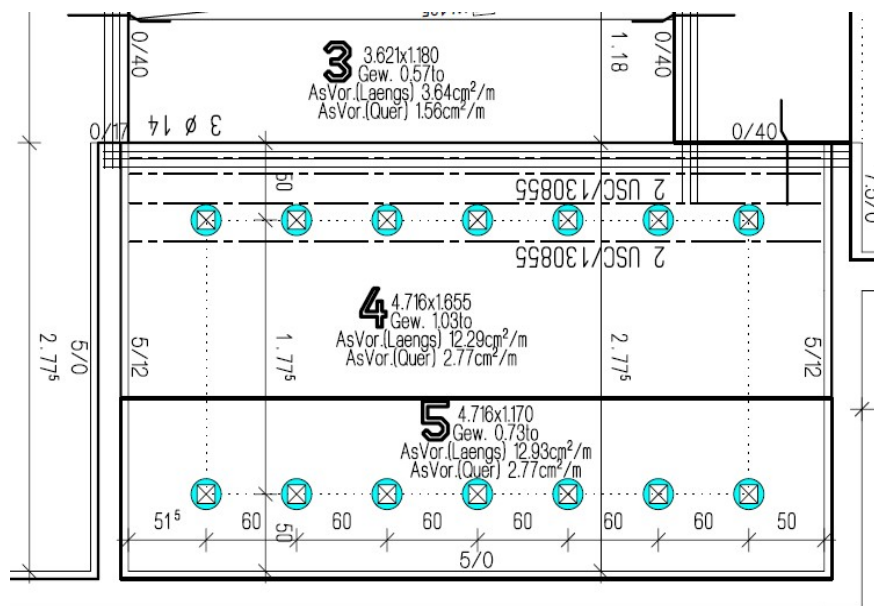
Werkzeichnung einer Elementdecke<sup>123</sup>
